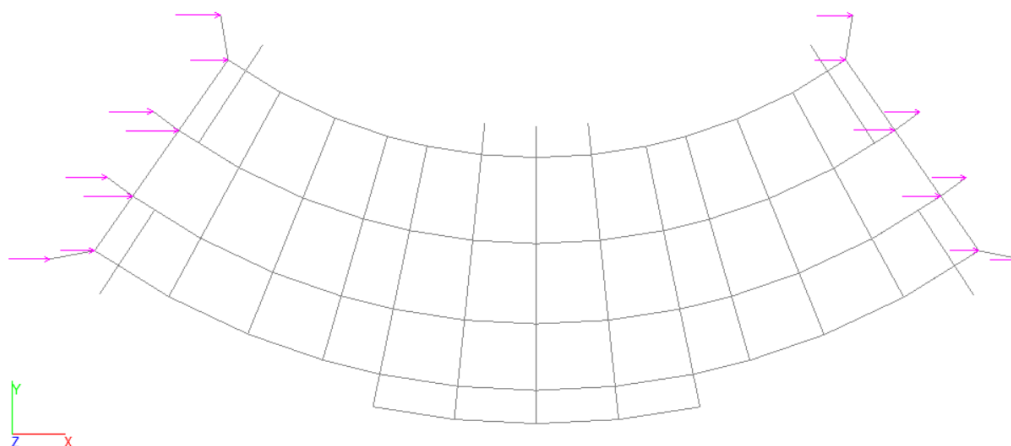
Схема приложения нагрузки от межкомнатных и межквартирных перегородок
